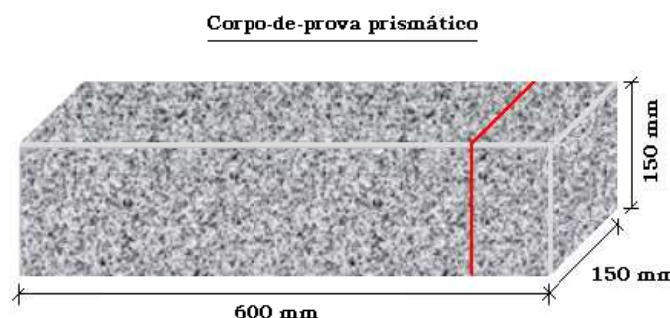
Corpo-de-prova prismático, moldado para corte das placas, simbolizado pela linha vermelha.
